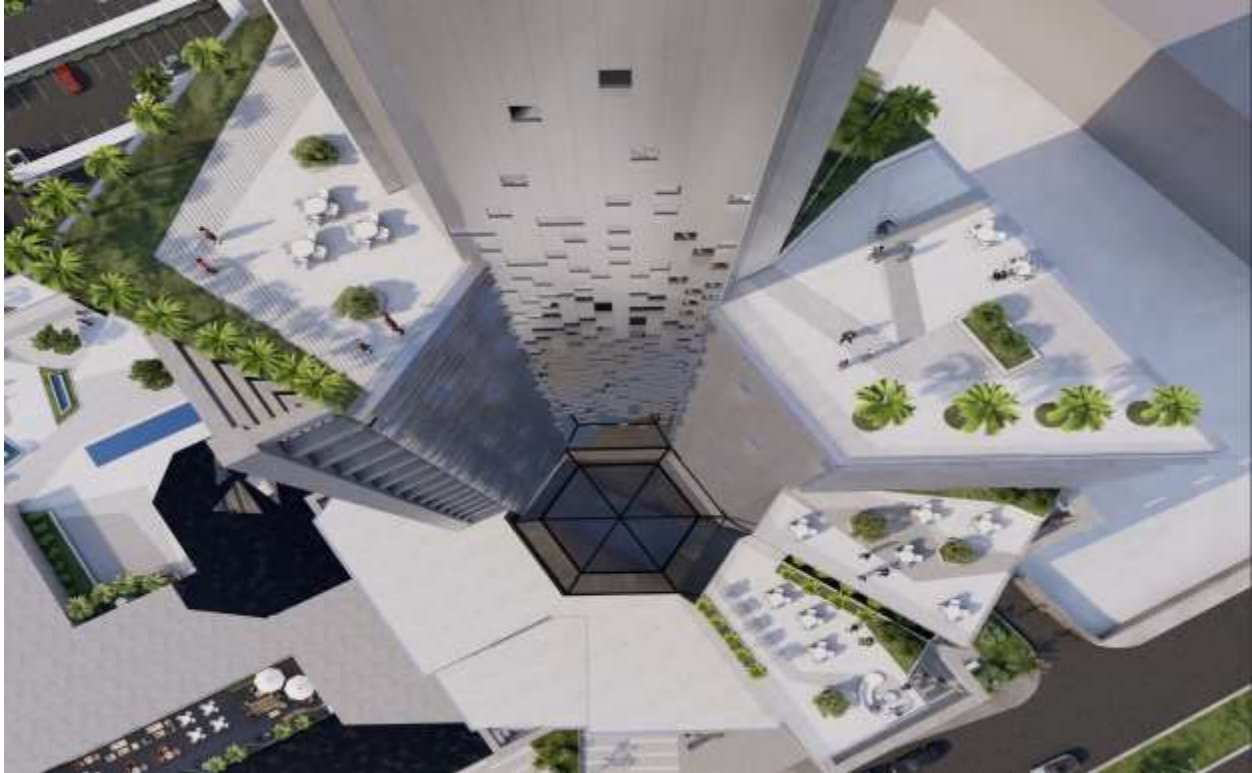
Vista Dimensionamiento 3d Vista Superior Fuente: El Autor (2023)
